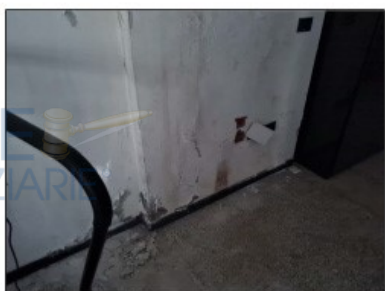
UMDITA' DA RISALITA PIANO INTERRATO
